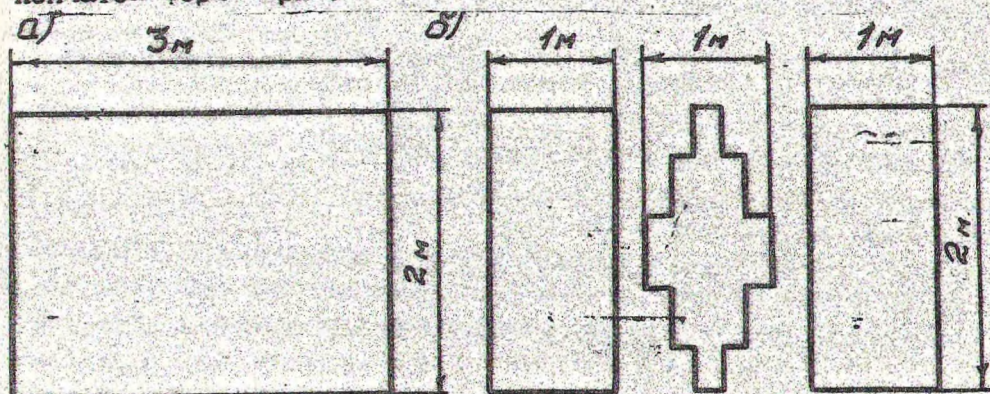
Конструкции поверхностей: а - сплошная, б - сборная
